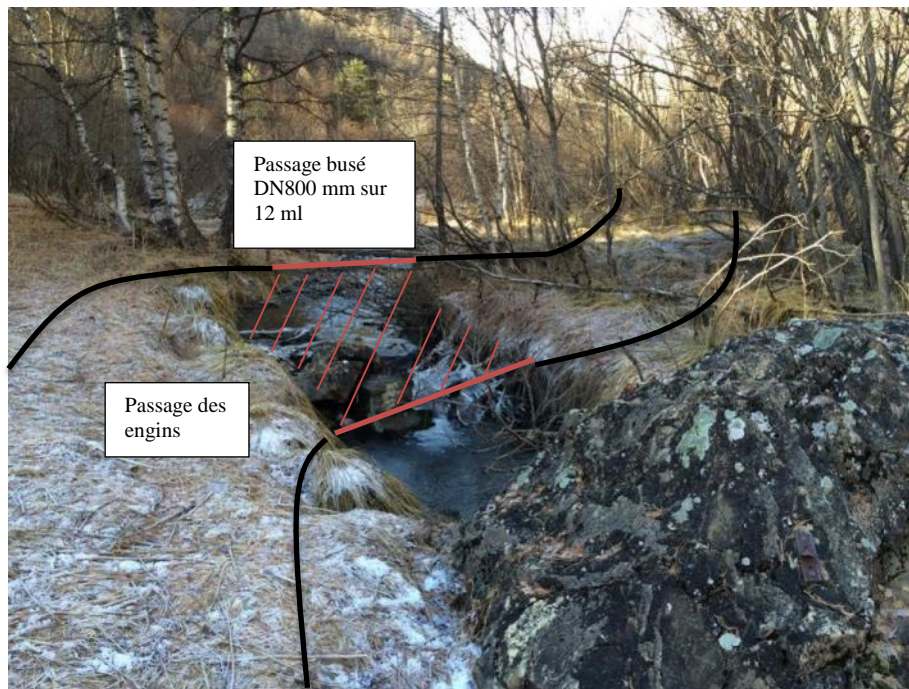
Traversée du ruisseau par les engins (16/12/16)
